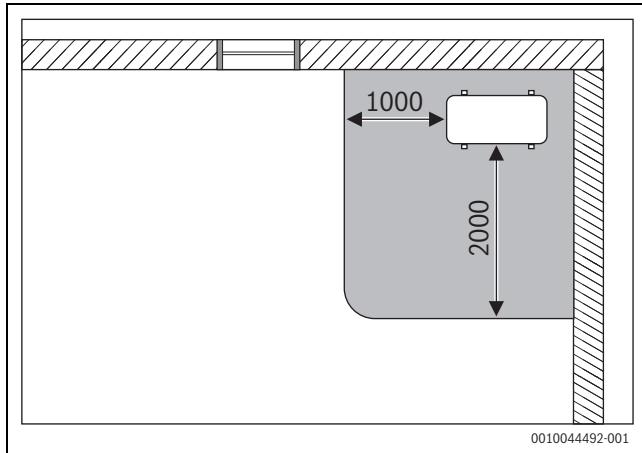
Защитена зона, подово стоящо външно тяло до стена (размери в mm)
